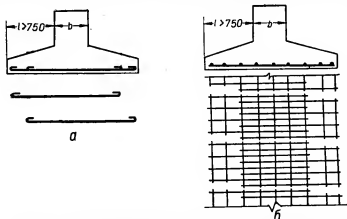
148. Армирование плиты ленточного фундамента при вылете свесов более 750 мм:
